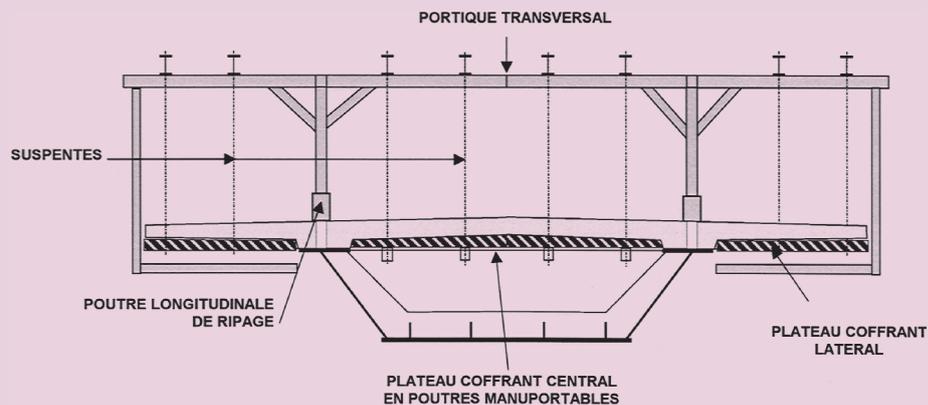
Équipage mobile pour caisson sans pièces de pont
